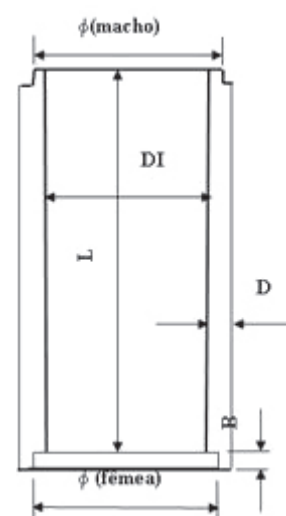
Tubo de concreto macho e fêmea (MF) - corte longitudinal
